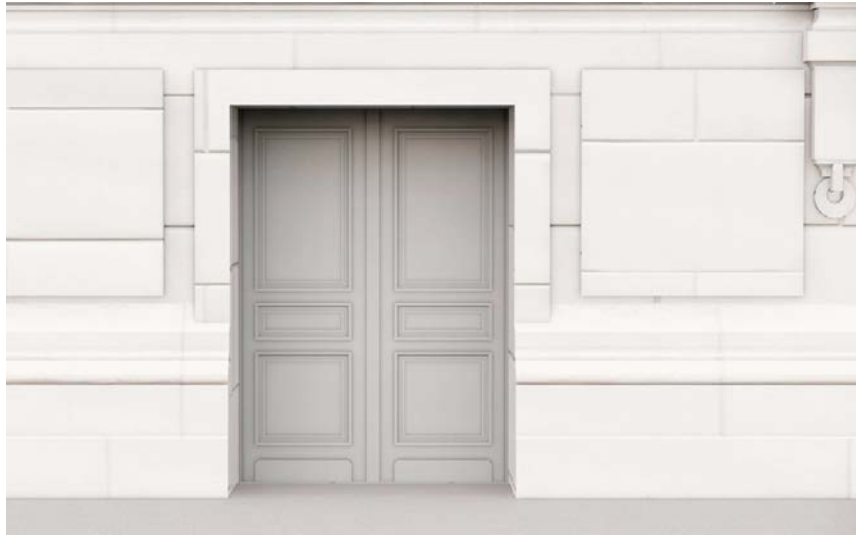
Traitement porte issue de secours sur la façade de l'avenue W. Churchill. © François Chatillon Architecte
